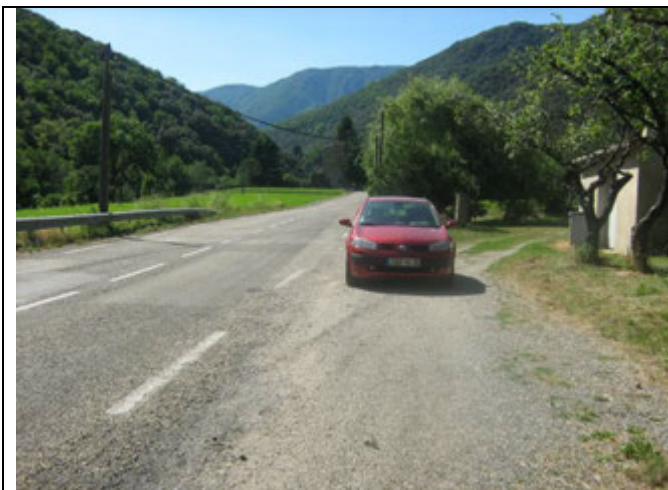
RD986 au droit de Camp Blas (plaine en rive gauche de l'Hérault en partie potentiellement inondable)
